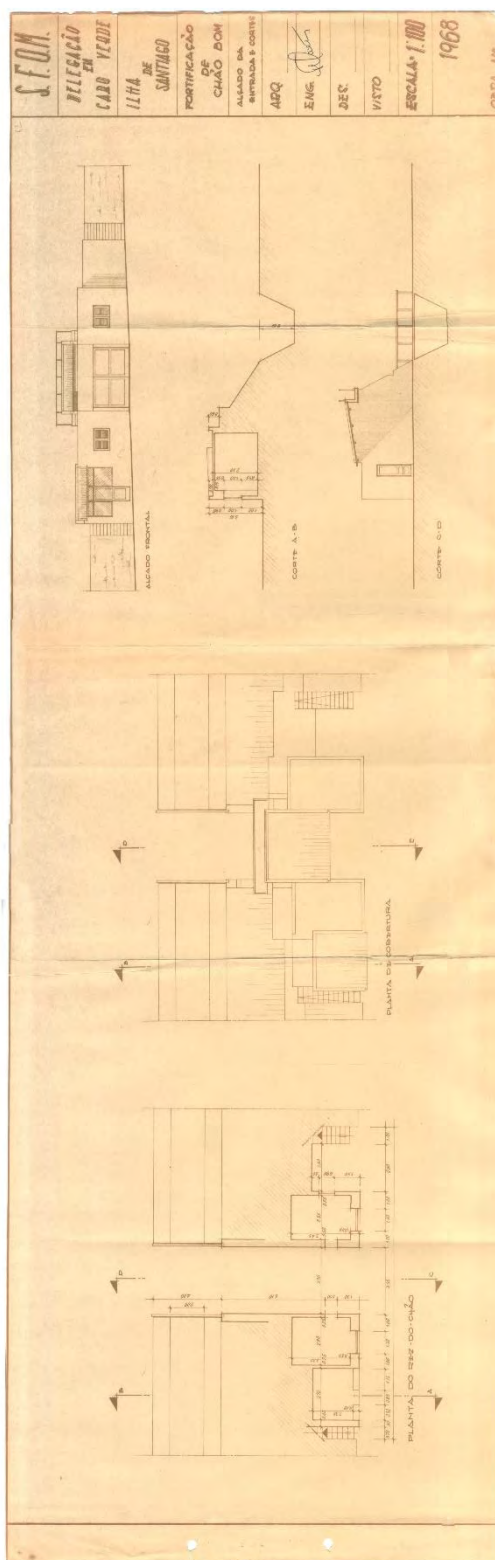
PLANTA DO PROJETO DA FORTIFICAÇÃO DA MURALHA
